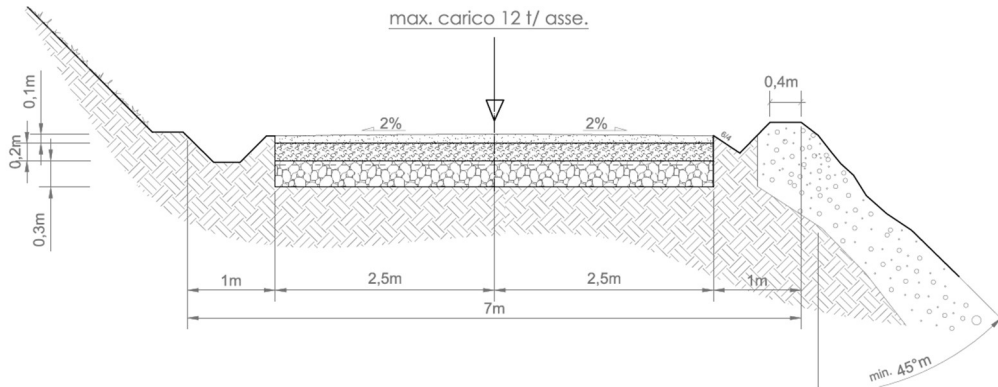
Sezione stradale tipo con scarpata (mezza costa)
